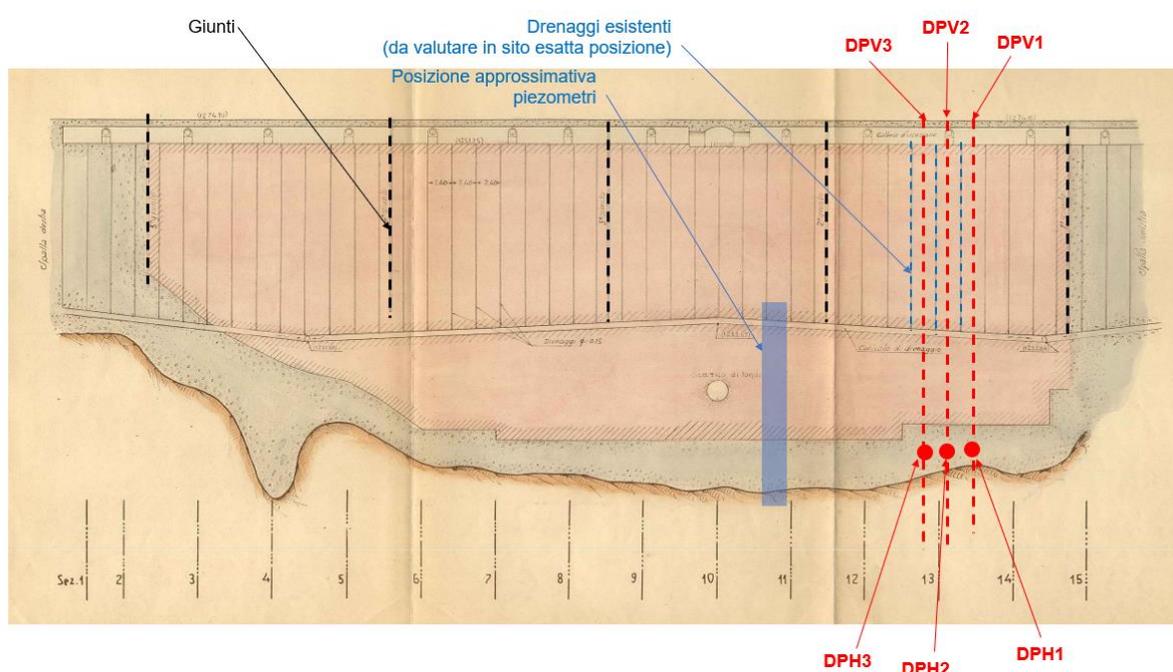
Profilo con ubicazione dei drenaggi di prova
